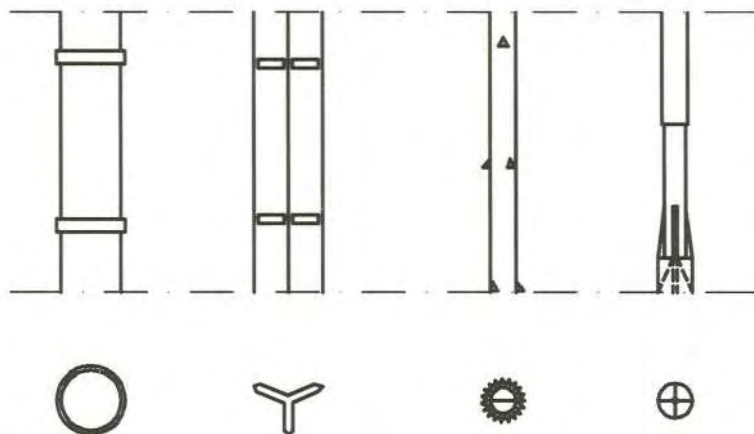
6 Prinsippskisse for installasjon av Steinsøylar (Stone Columns)
